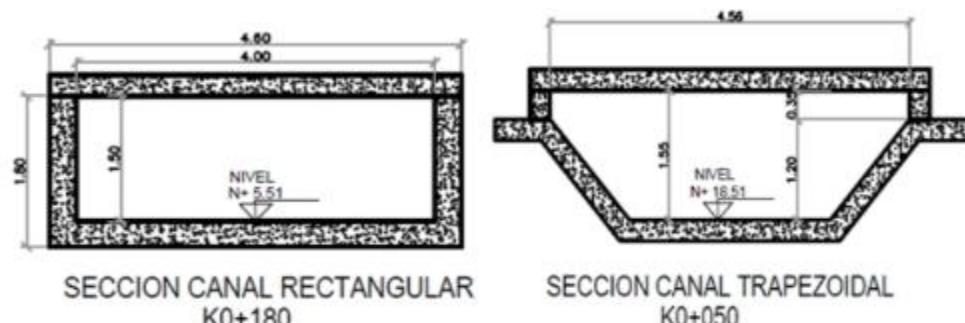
Geometría de la sección transversal. Dimensiones en metros.
